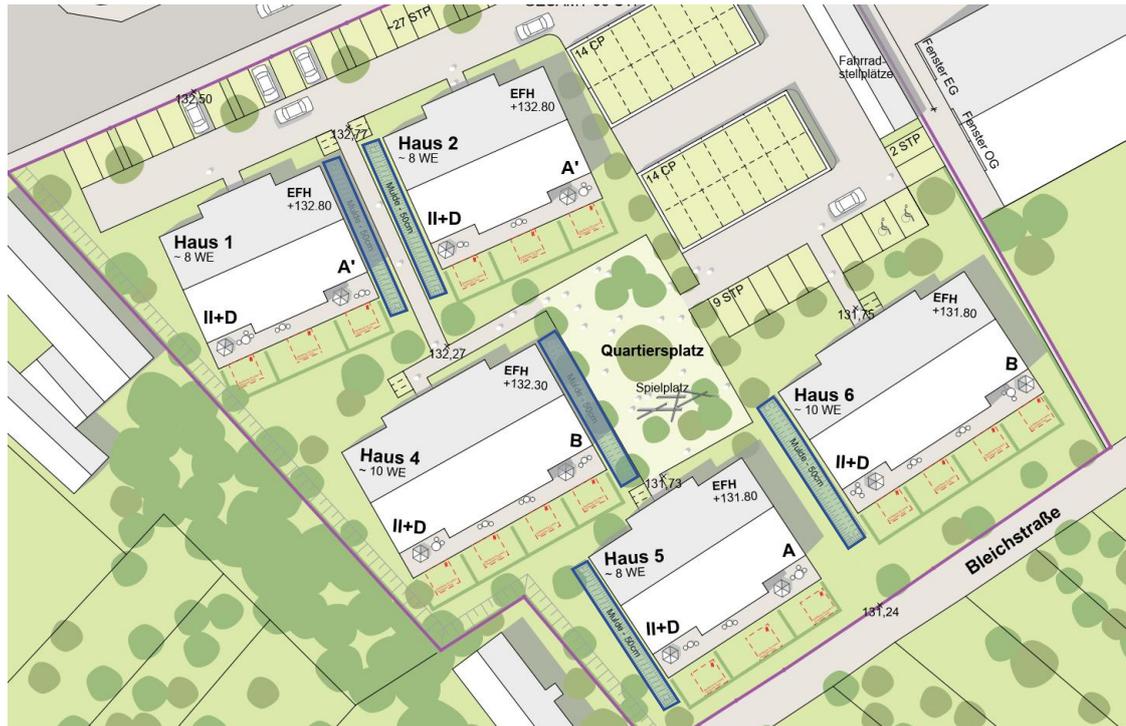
Auszug aus dem Lageplan Büro GJL vom 06.09.2022 mit dargestellten Versickerungsmulden
